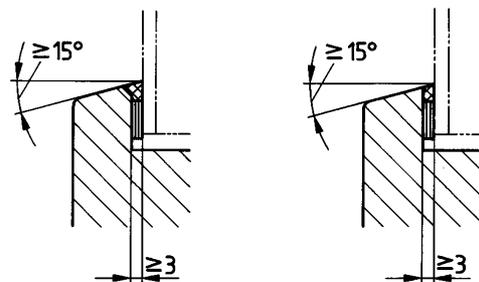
Ausbildung des Glasfalzanschlages mit und ohne Fase
